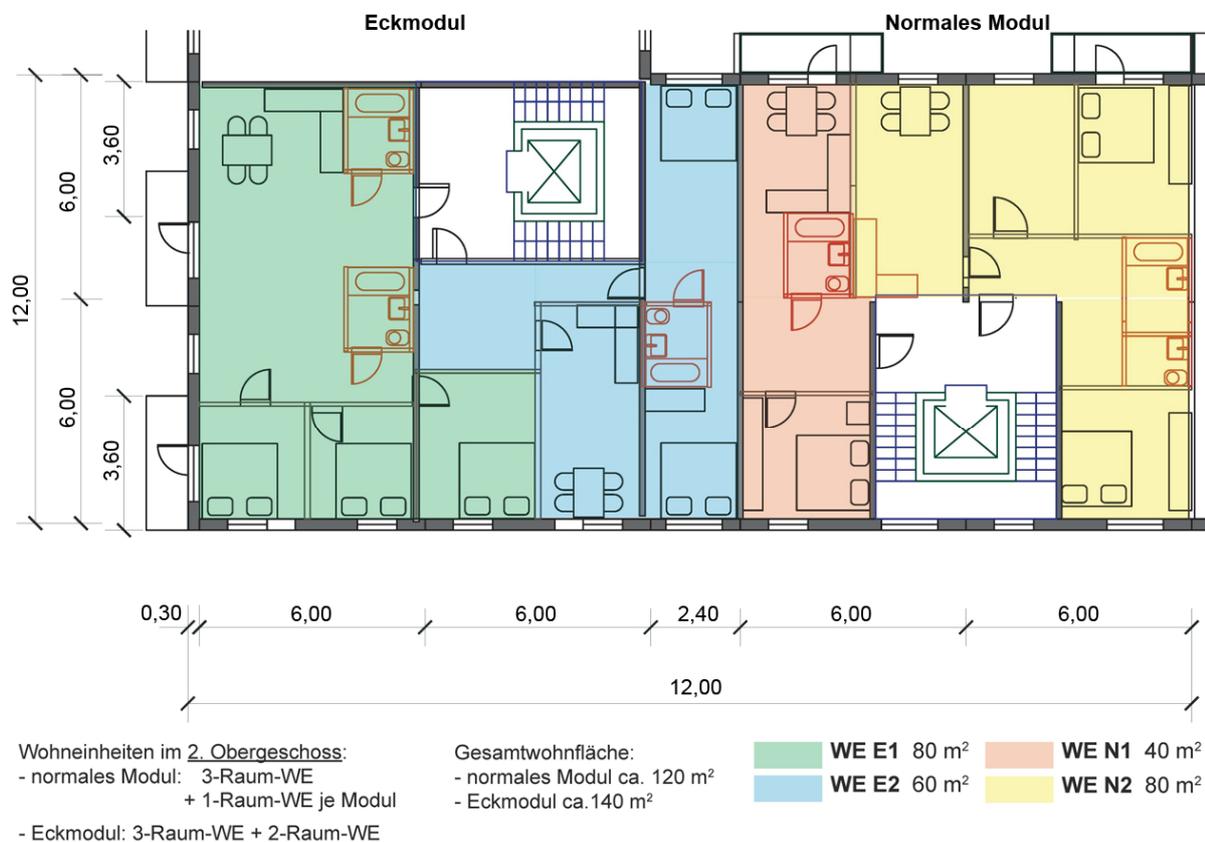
Grundriss 2. Obergeschoss, Ausschnitt (M 1:200)
